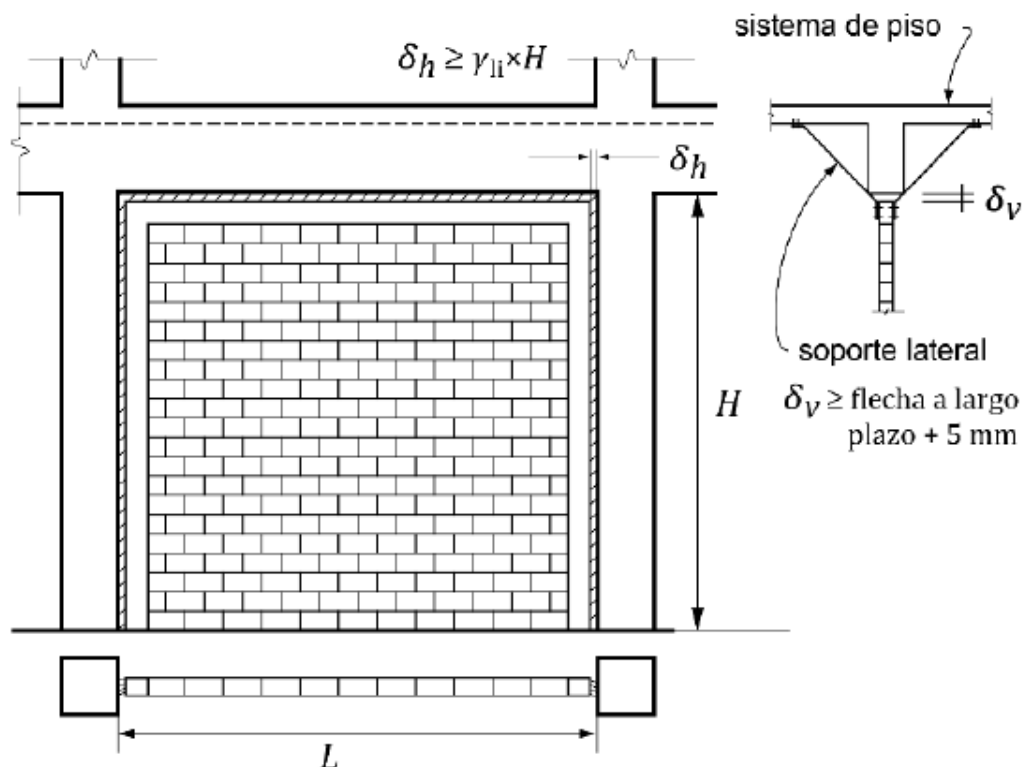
Holguras entre muros no estructurales y columnas y vigas (GCM 2017).
